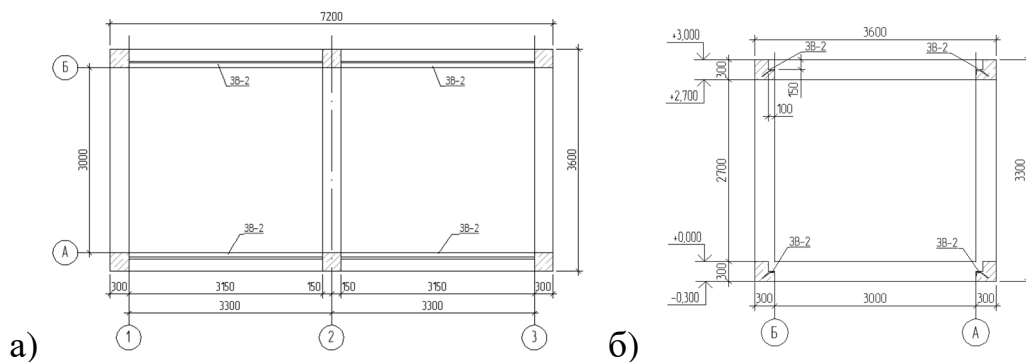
Залізобетонний модуль: а)-план; б)-поперечний розріз
